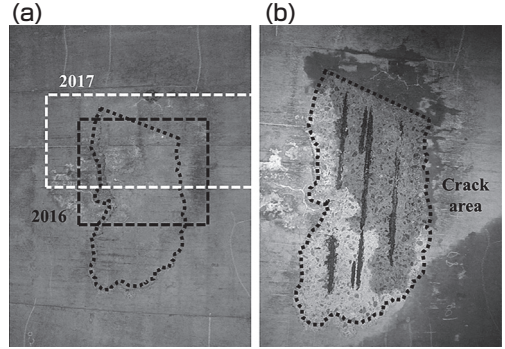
叩き落し作業前後の状態 (a)作業前 (b)作業後
